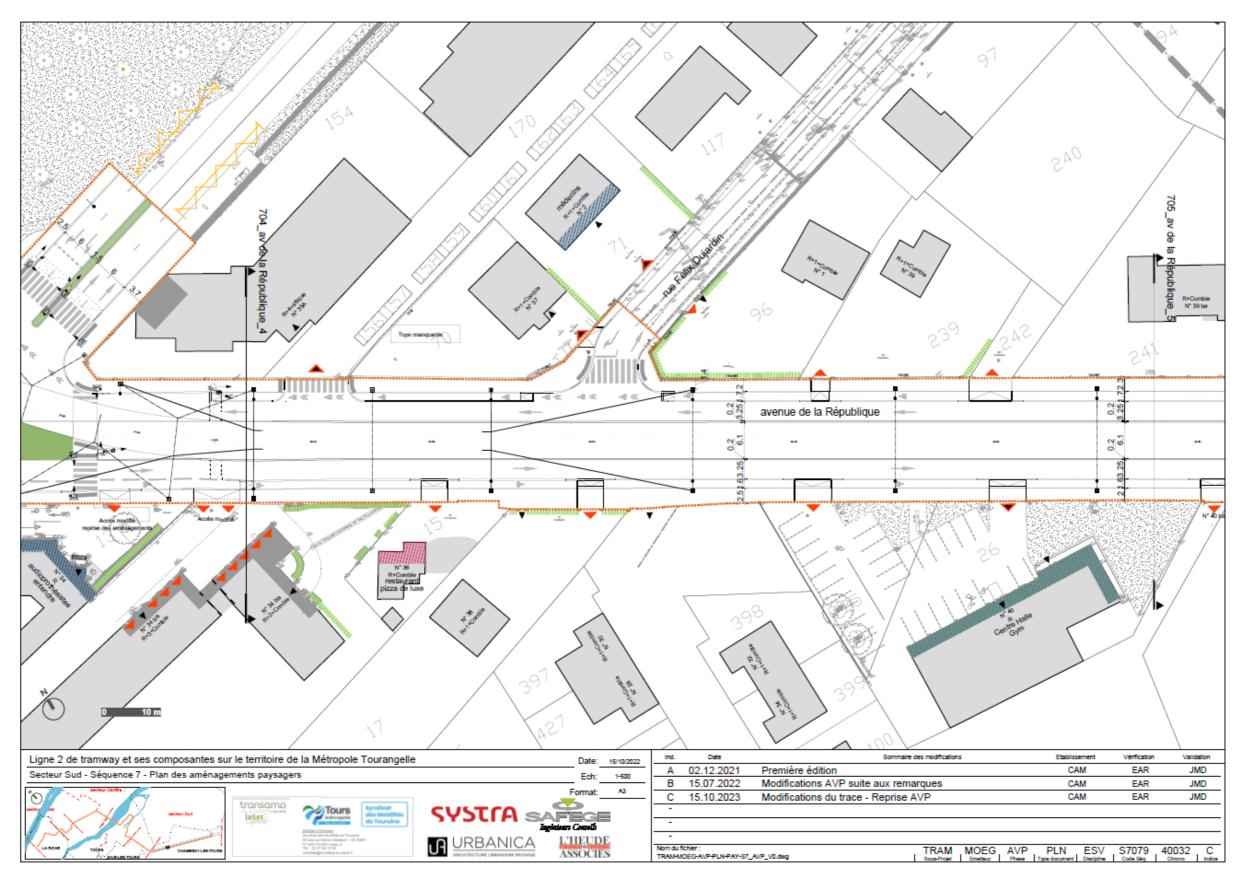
plan masse de localisation des arbres à abattre sur avenue de la République – Section 2 (planche 7)
